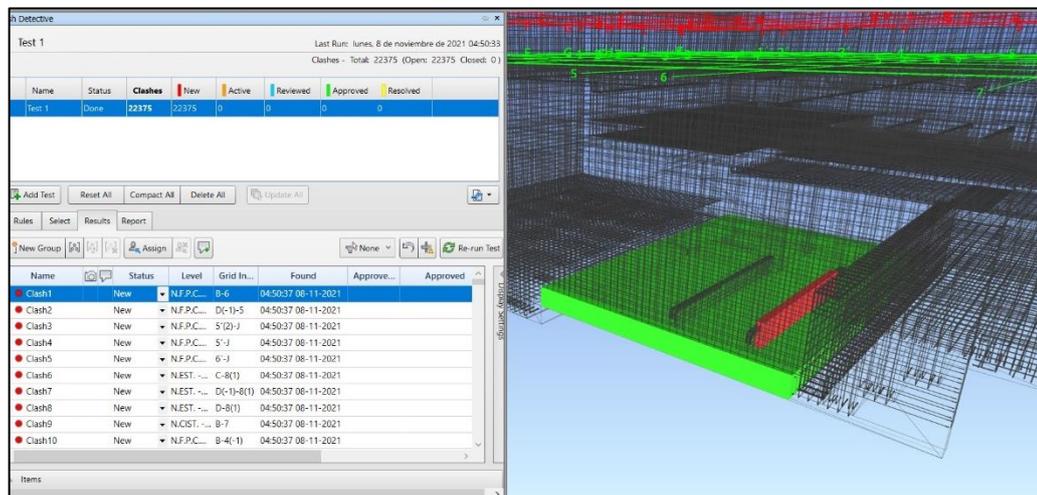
Interferencia de viga con losa de cimentación en Navisworks
